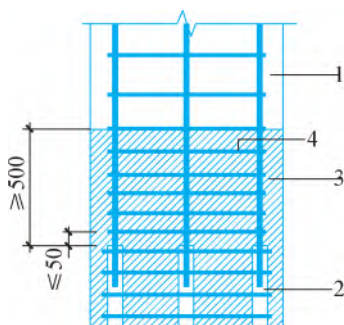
钢筋采用套筒灌浆连接时柱底箍筋加密区域构造示意
